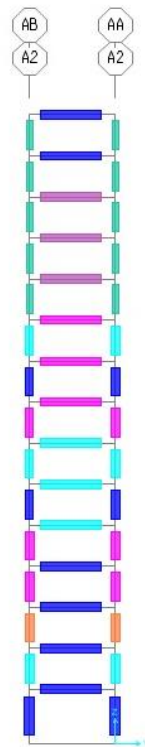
Plano X-Y @Z= 4.8 (vista en planta y detalle en excentricidades aplicadas en los ejes)
